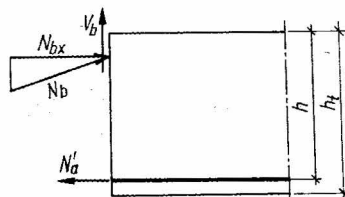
Disposition des efforts dans une section verticale, dans la zone de cisaillement d'une poutre en béton armé, d'après BAY
